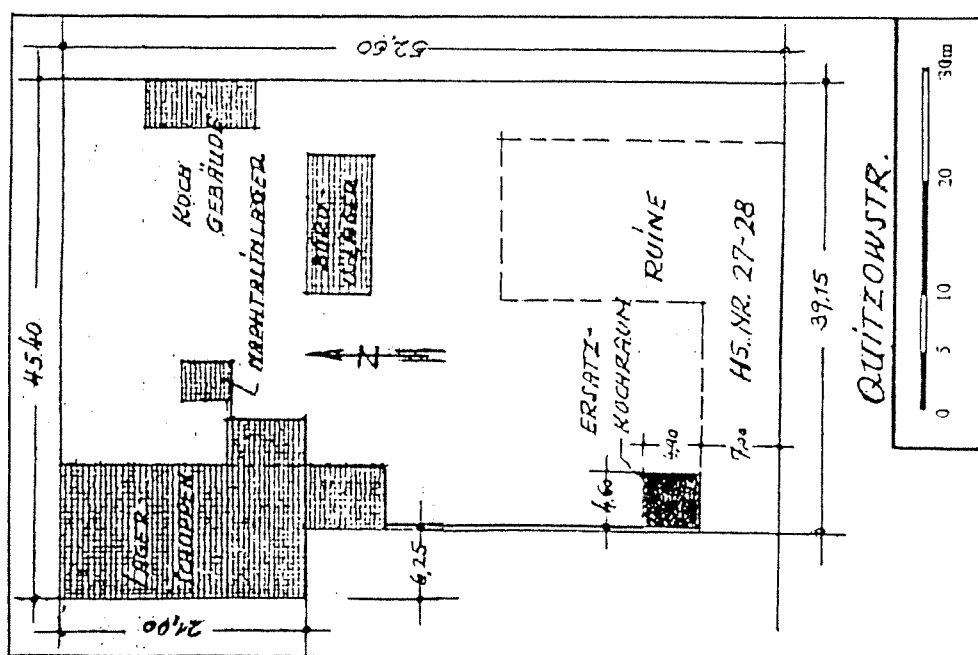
b : Verdachtsfläche 7 - Bebauungssituation 1951 (Nr.27-28)
